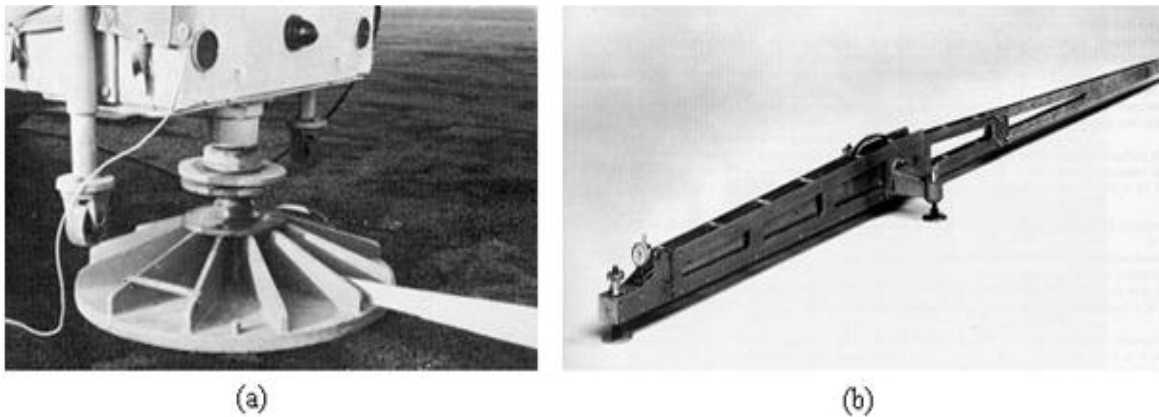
Essai de plaque, d'après Nguyen, (2008)
